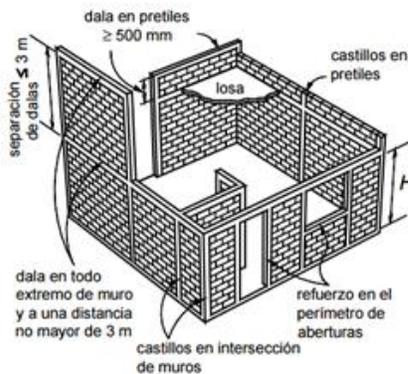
Muro Confinado. Fuente: Torres (2003). Pág. 78
